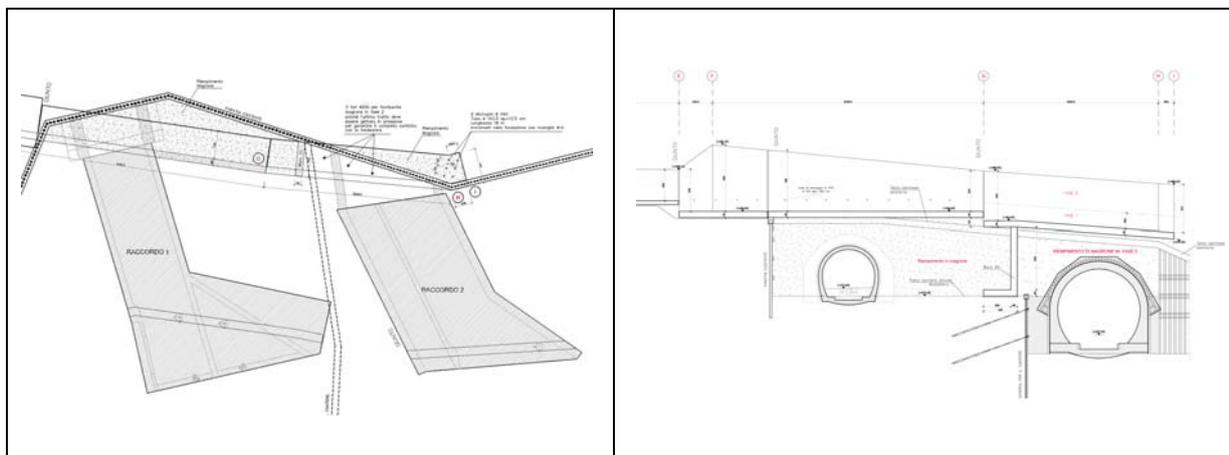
pianta strutture di collegamento e prospetto imbocco
